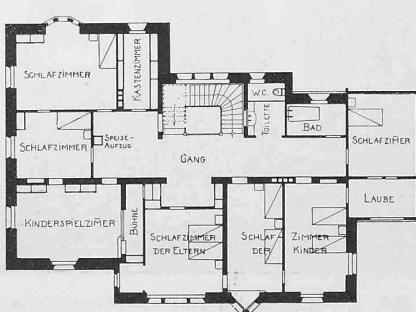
Grundriss vom ersten Obergeschoss. — Masstab 1:400.
